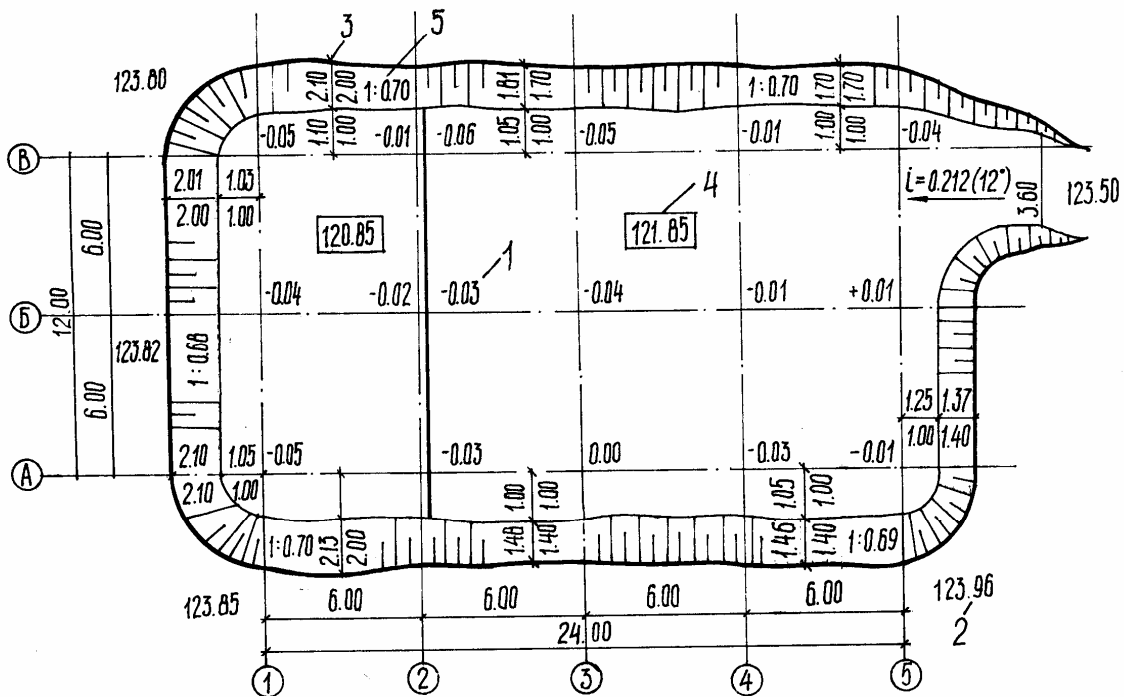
Исполнительная схема плано-высотной съемки котлована:
